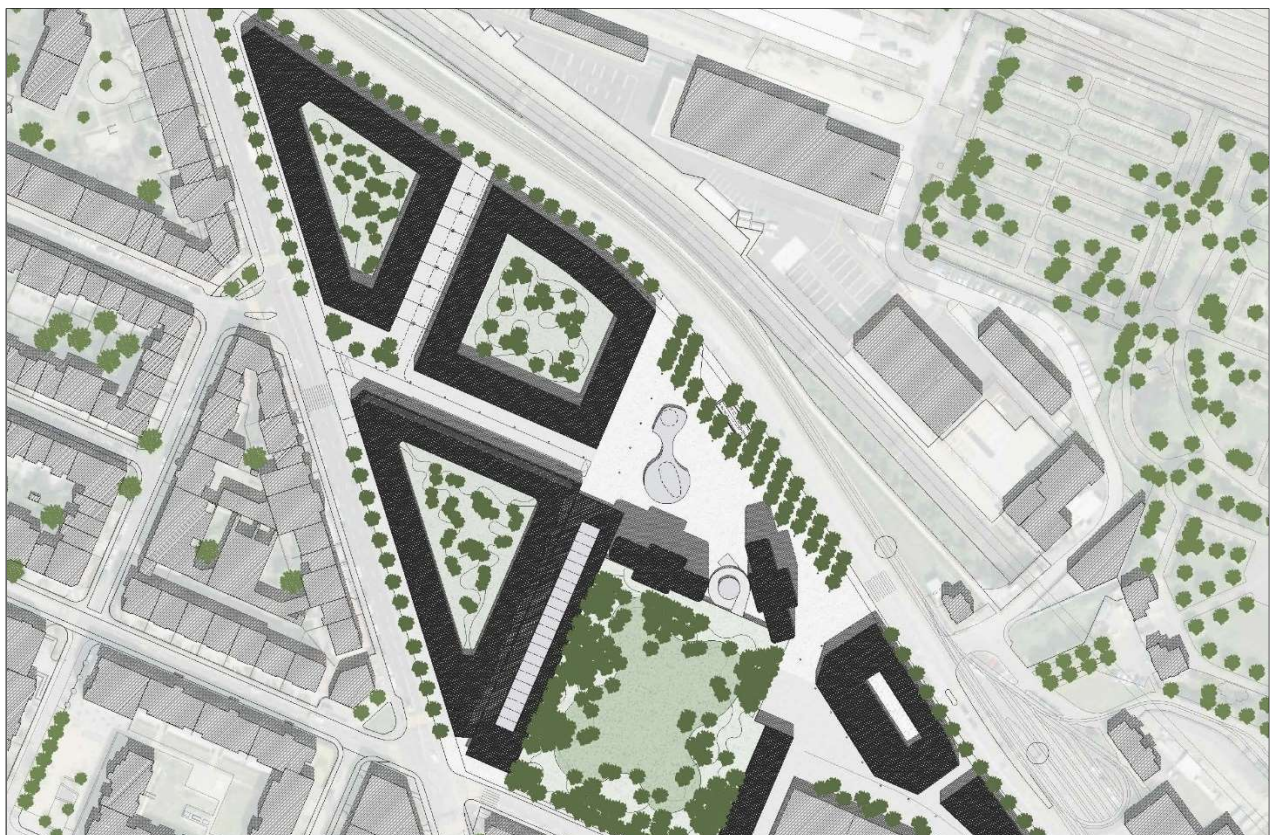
Vorschlag Diener & Diener. Situationsplan (Plan genordet, kein Massstab). Quelle: Diener & Diener
